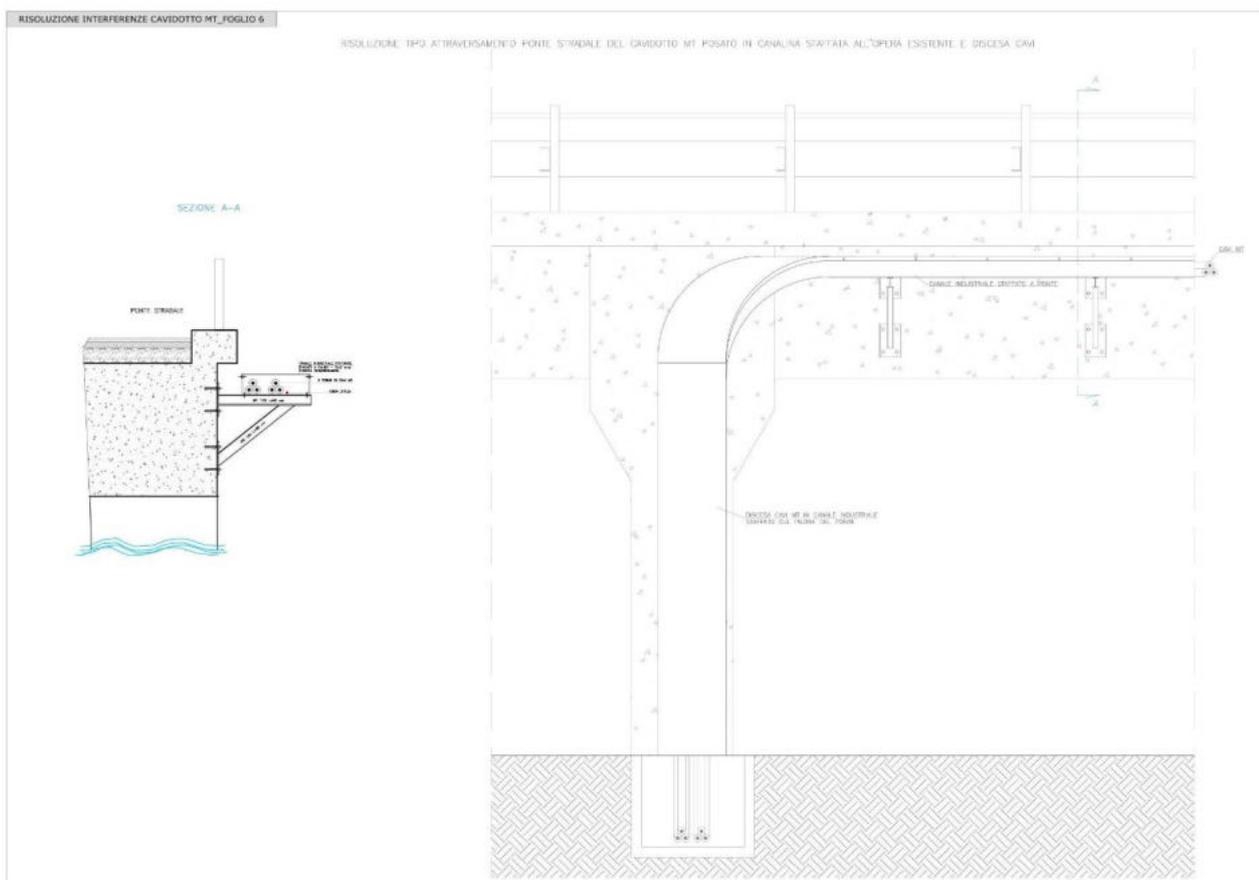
Risoluzione con posa in canalina del cavidotto.
